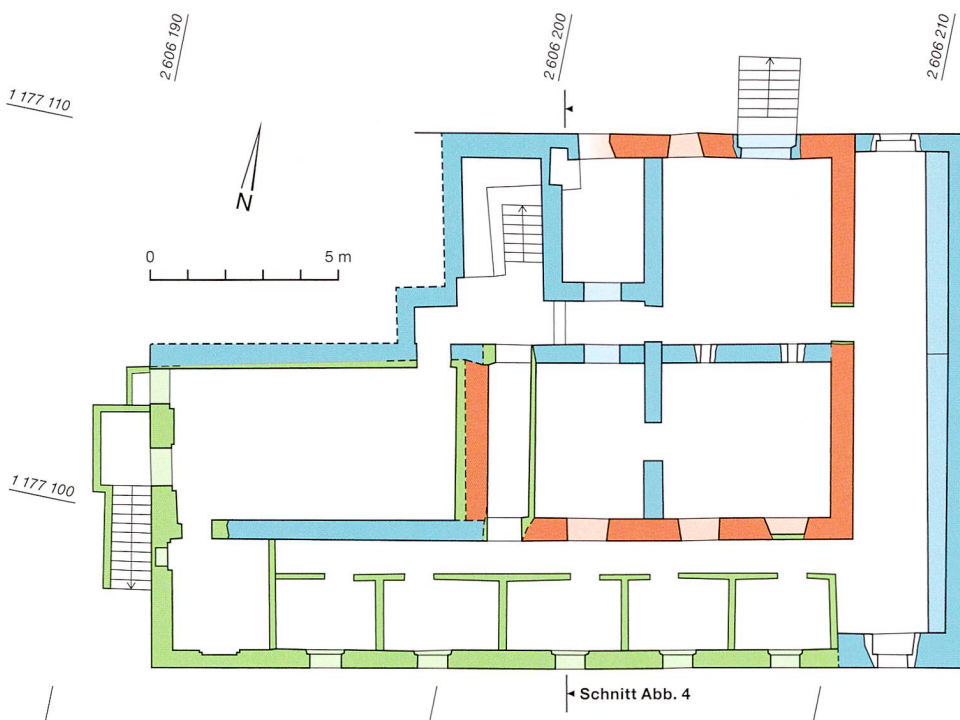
Blumenstein, Badstrasse 37. Grundriss Kellergeschoss. Der ursprüngliche Kernbau (rot) aus der Zeit um 1600 wurde in den Neubau (blau) von 1879 integriert. Die Baderäume südlich des Kernbaus (grün) entstanden 1932. M. 1:200.
